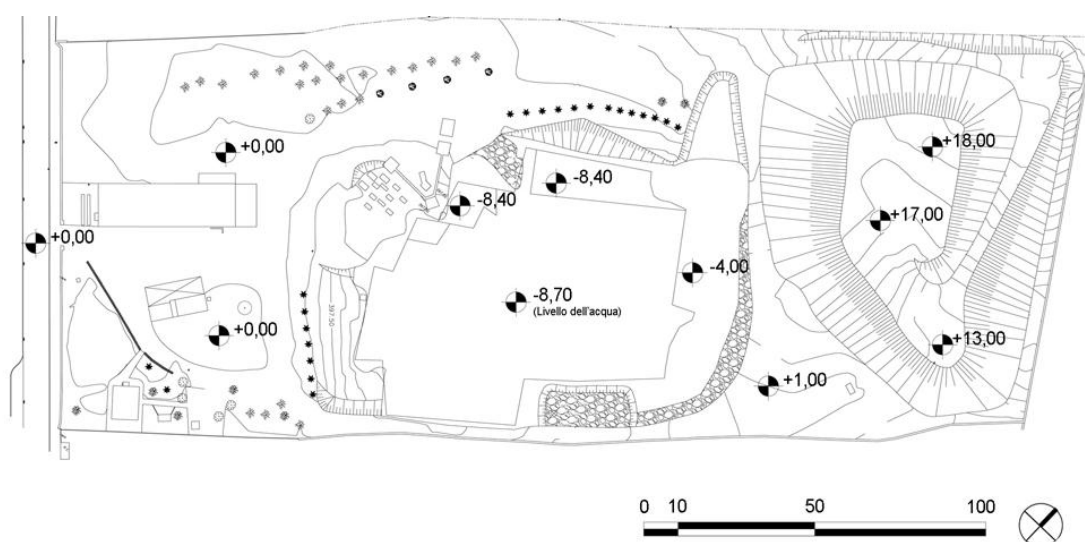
Stato di fatto del sito di progetto. Planimetria
